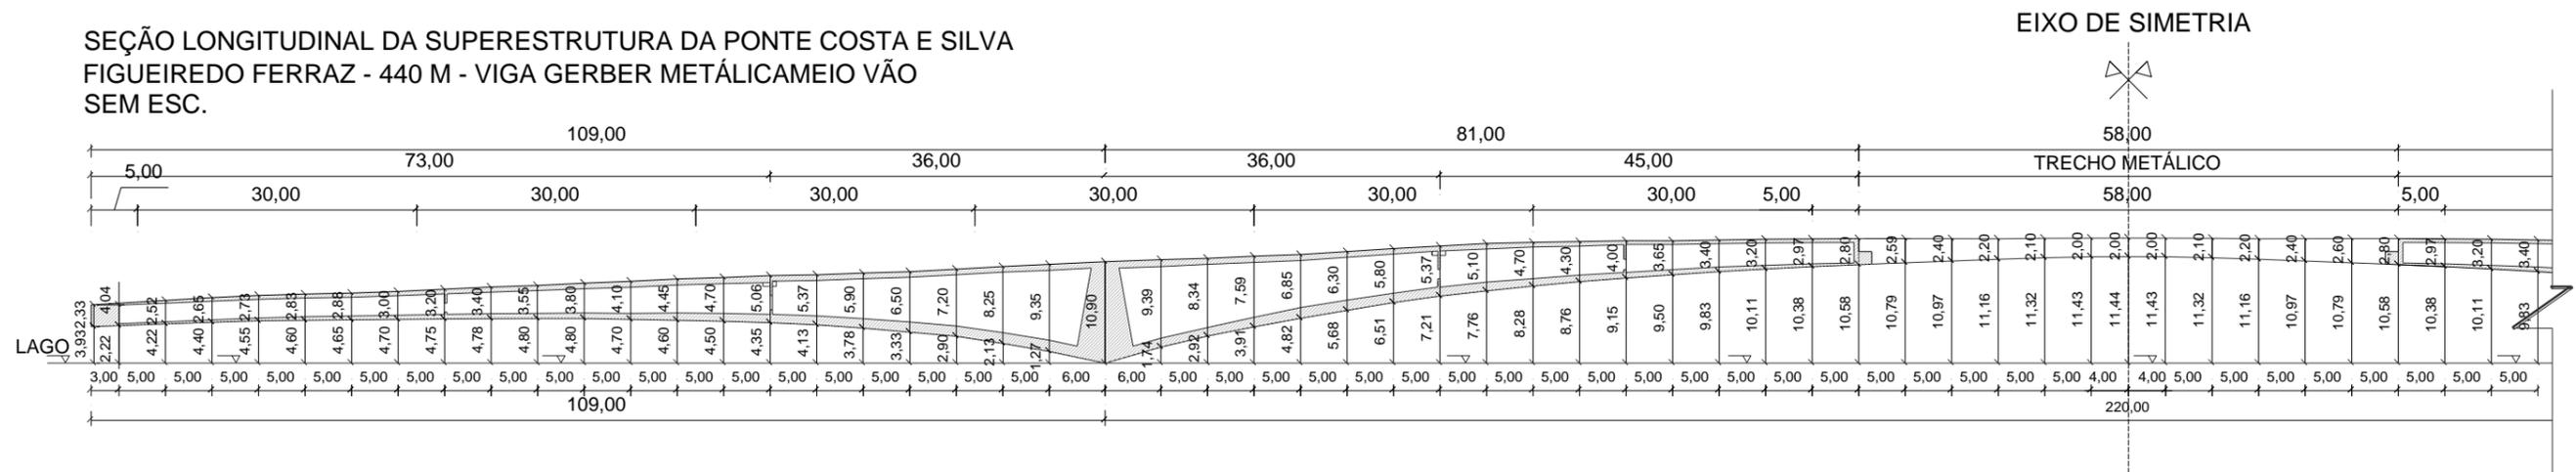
Seção Longitudinal da ponte terminada mostrando a viga metálica Gerber utilizada para conclusão da superestrutura. Desenhos CAD realizados pelo autor segundo projetos originais. Fonte: (DE – DVO – NOVACAP, 1969).
